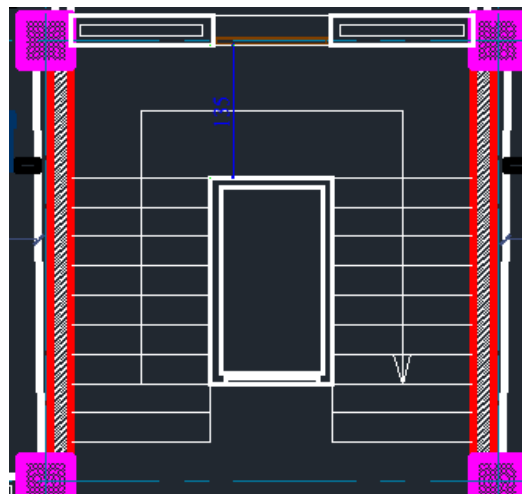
PLAN DE LA CAGE D'ESCALIER
